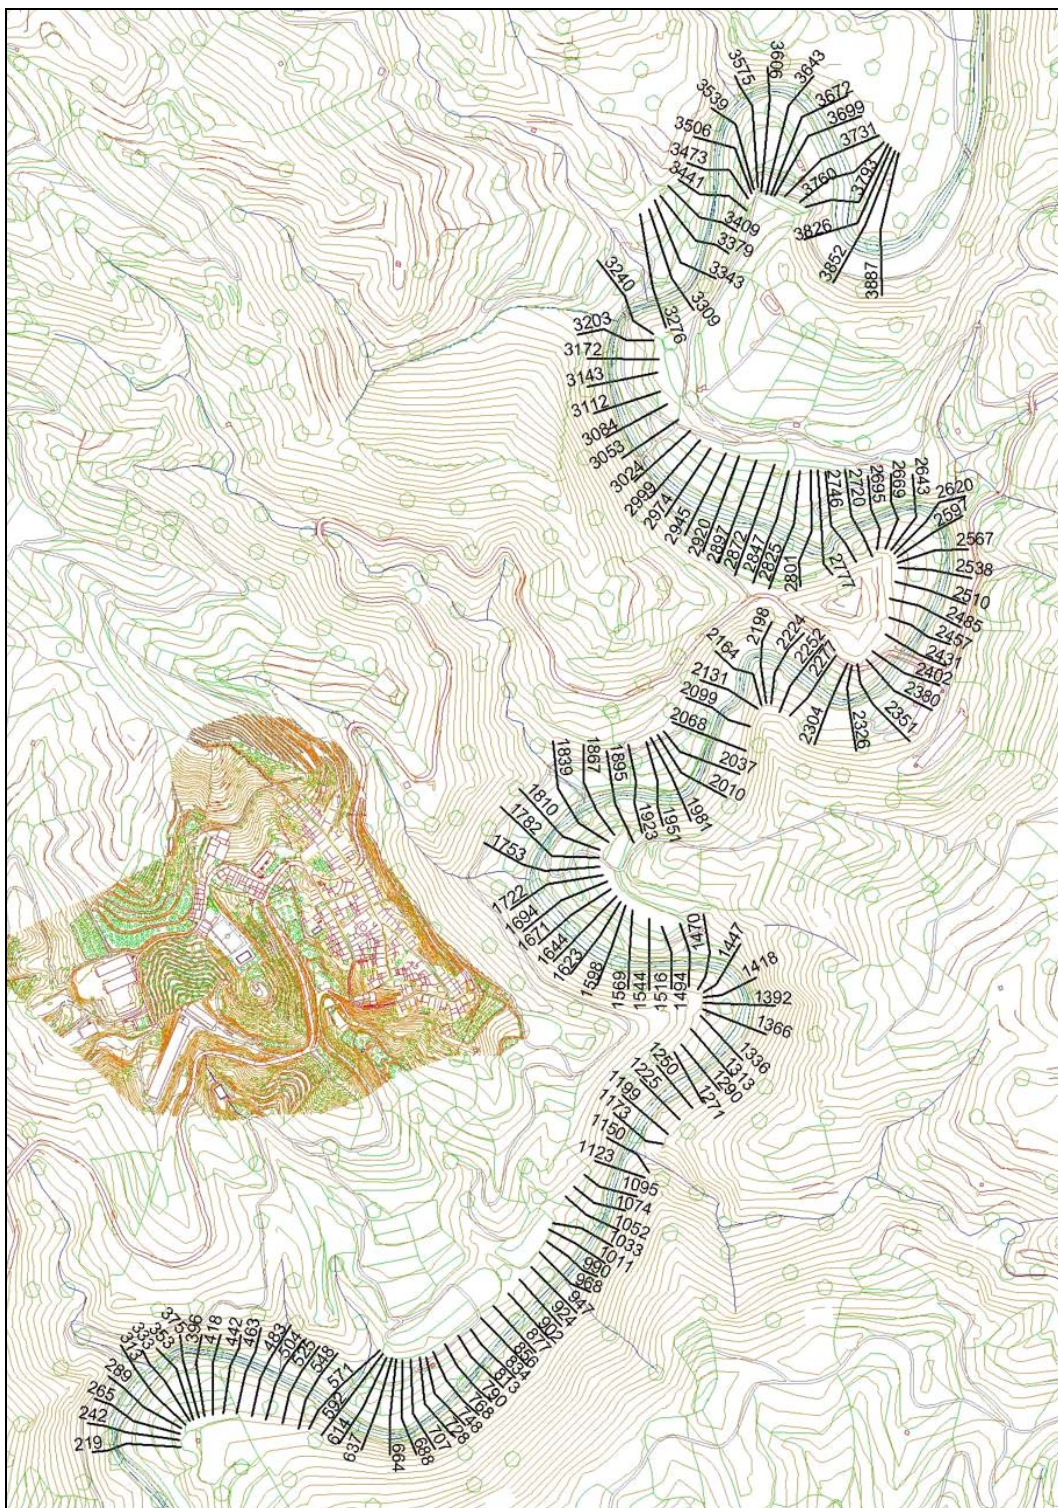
Posició en planta de les seccions de càlcul al municipi el Lloar.
